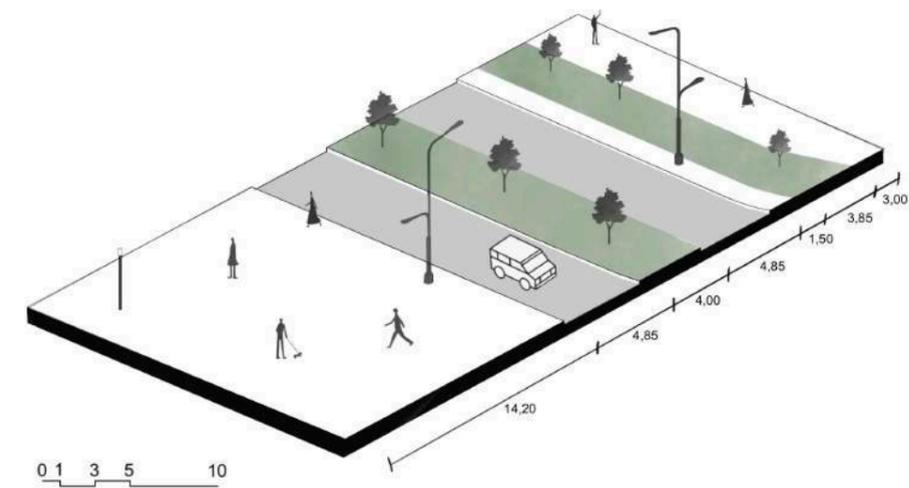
Calle Chapetones sección nueva. Fuente propia.
